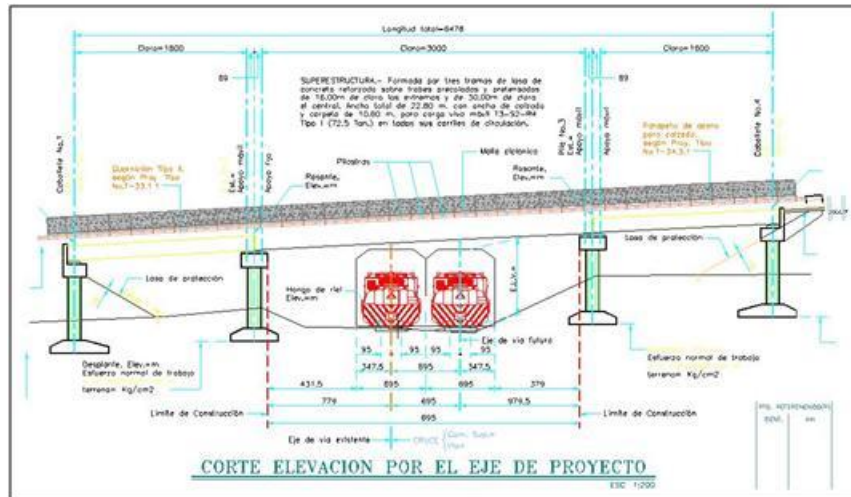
Elevación por el eje del proyecto, se observa la estructura principal a base de columnas y traveses prefabricados de concreto armado.
